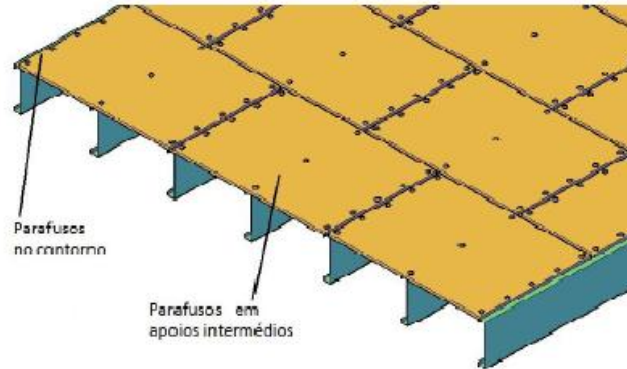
Pormenor da fixação do pavimento. [Silvestre, Nuno et al, 2013]
